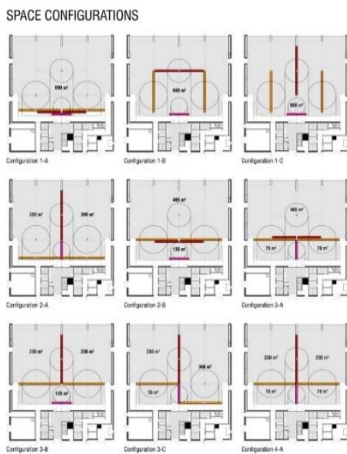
Possíveis configurações das paredes móveis do interior de *Concrete* | OMA
